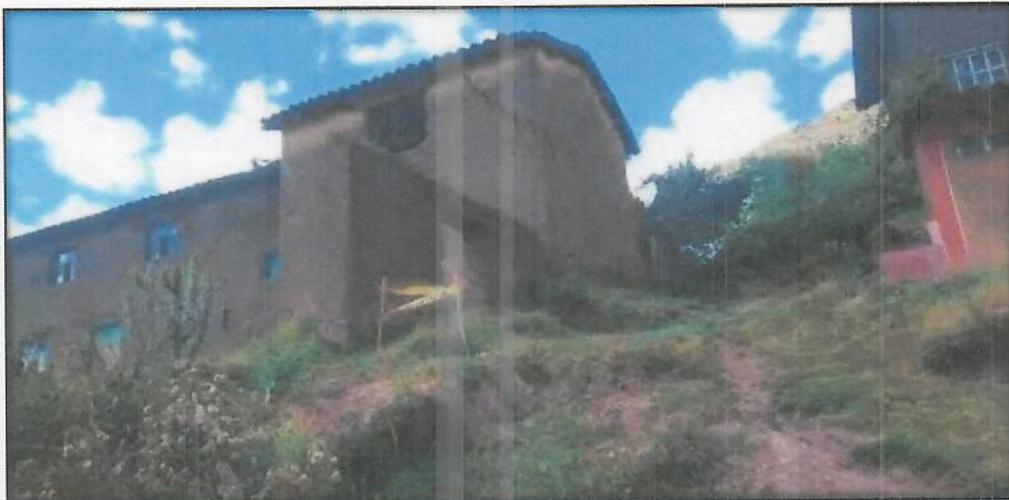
Viviendas con grietas en la comunidad de Cuyo Grande.
